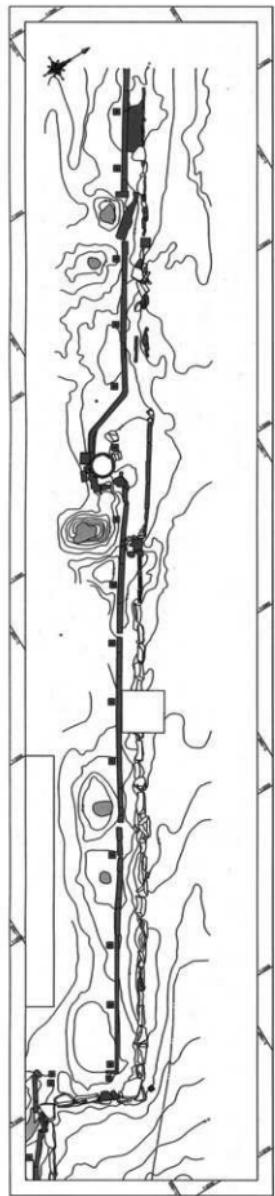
H25蓬松弘道館道路構造調査 平面図・立面図・断面図 5
